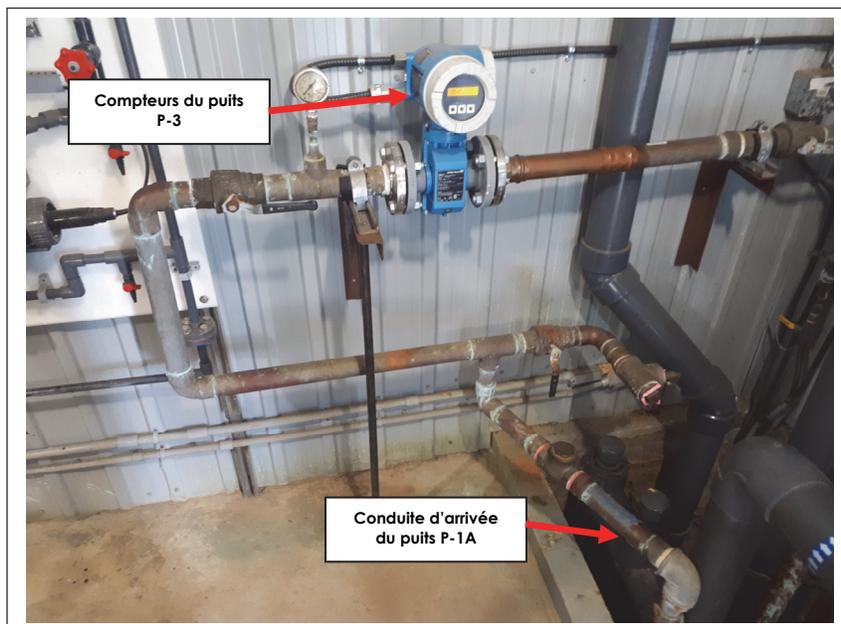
Vue de la canalisation associée aux trois puits du secteur Les Buissons (Photo 2 de 2) – 2020-05-21
